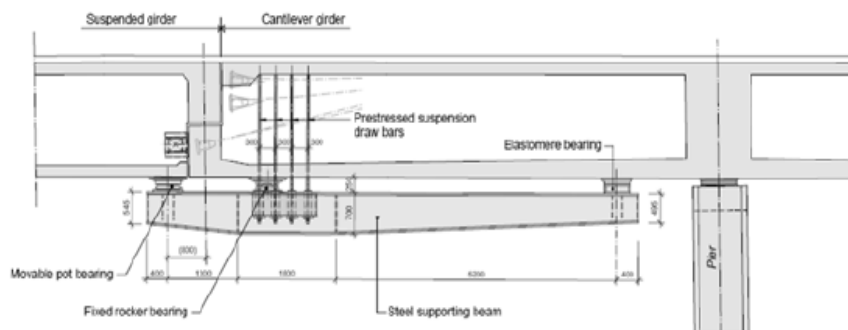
Installazione di travi di acciaio a sbalzo (Kun et al. 2015)
